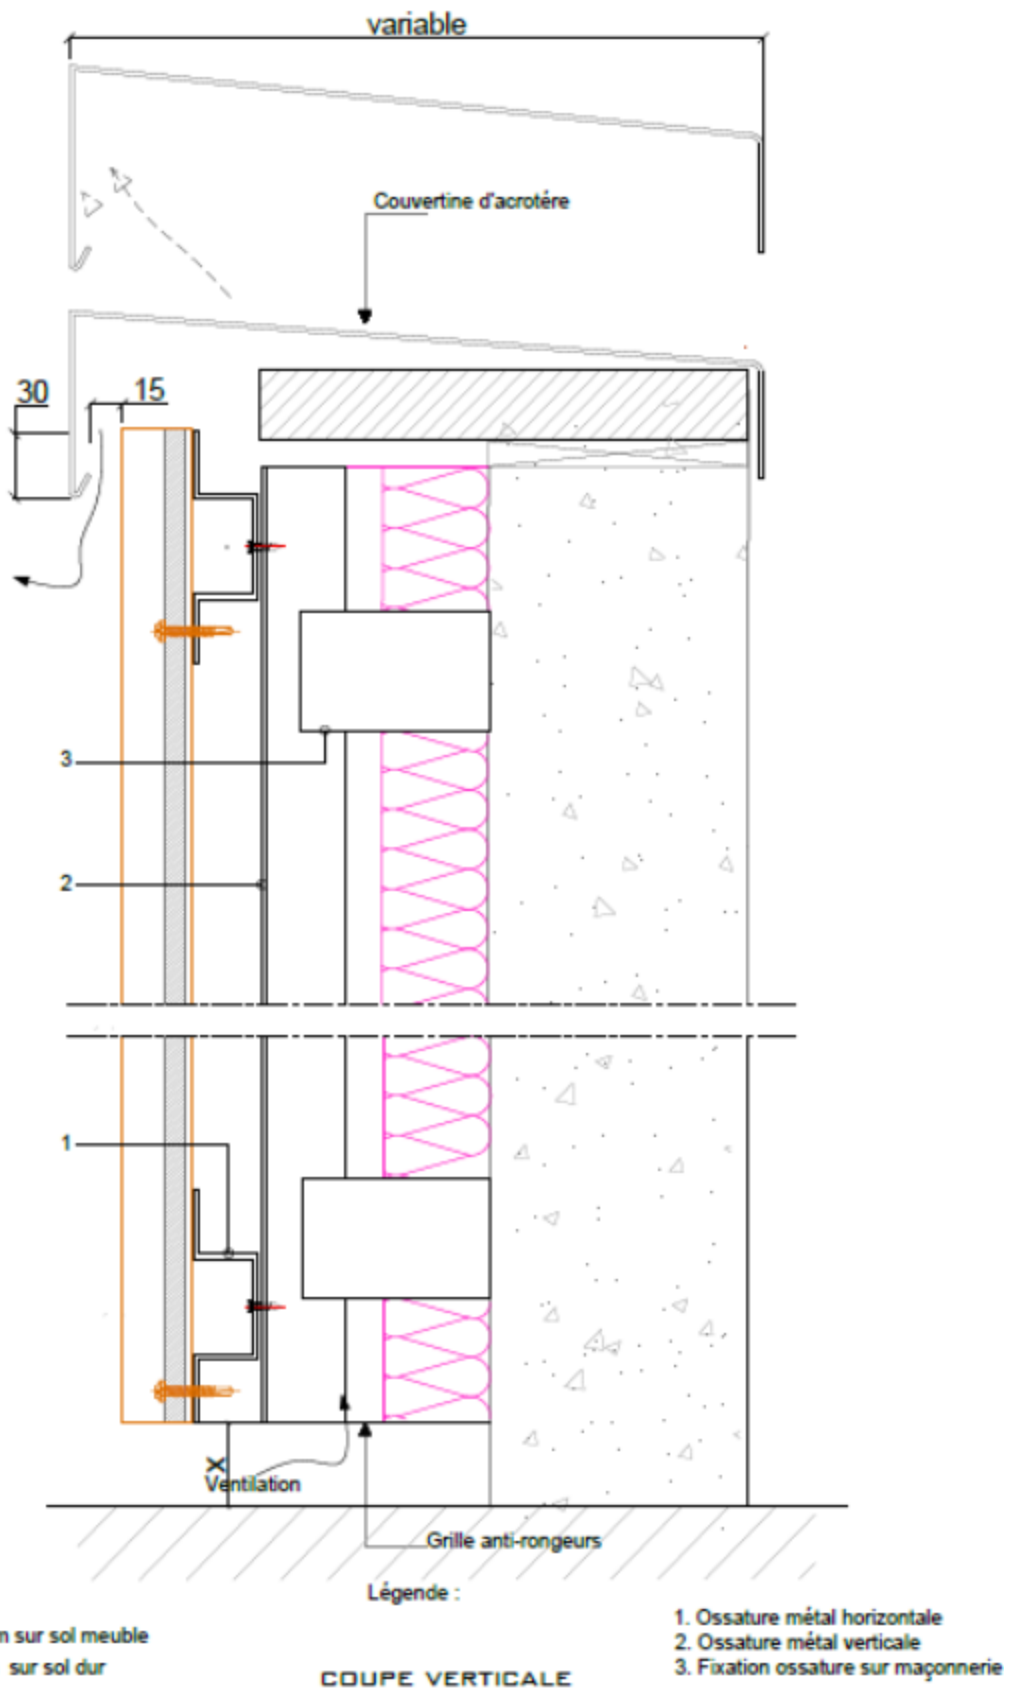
Départ et arrêt haut bardage sur ossature métallique en pose verticale - Coupe verticale
